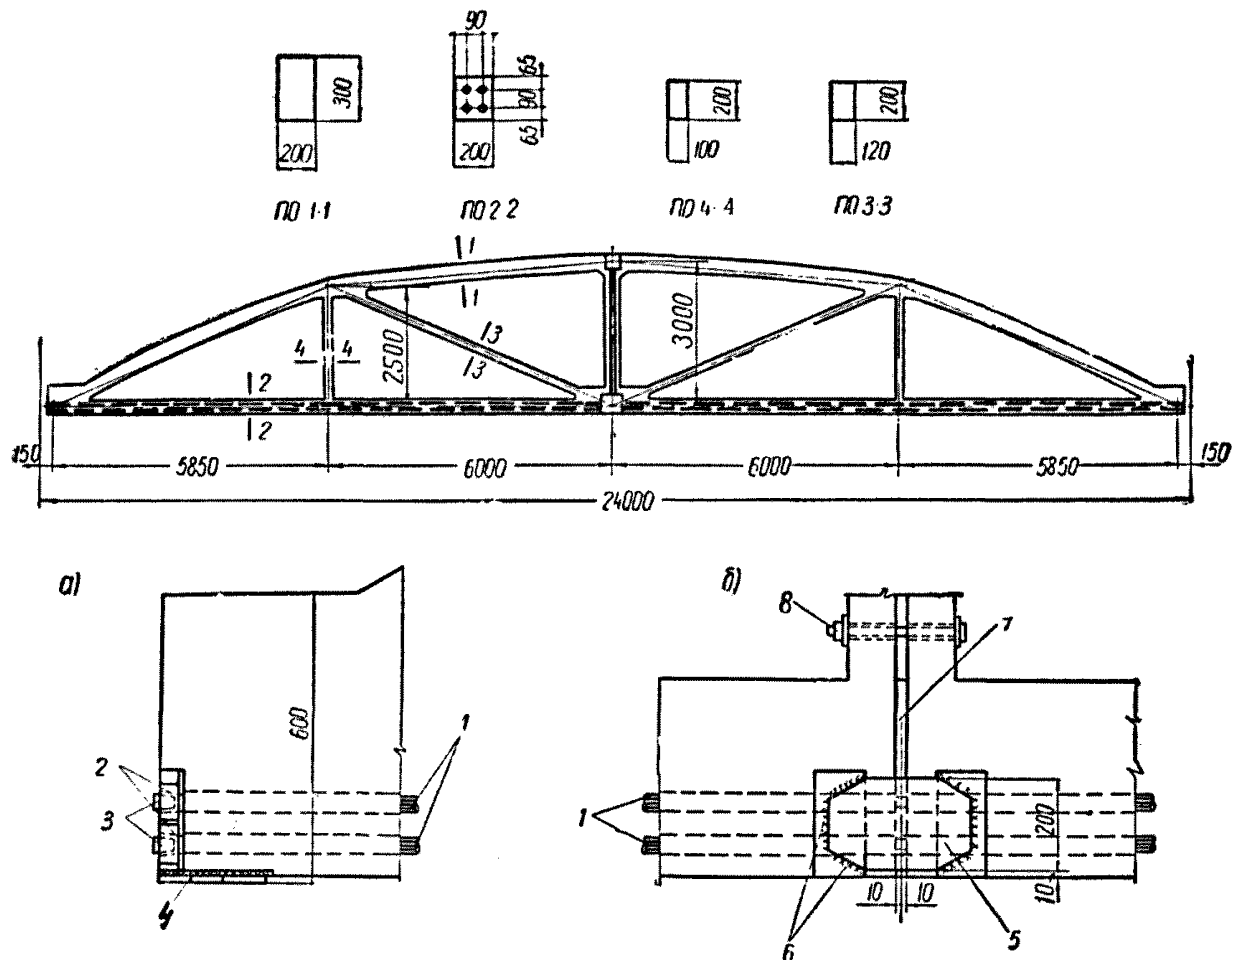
Предварительно напряженная составная (из двух половин) ферма с пучковой арматурой
